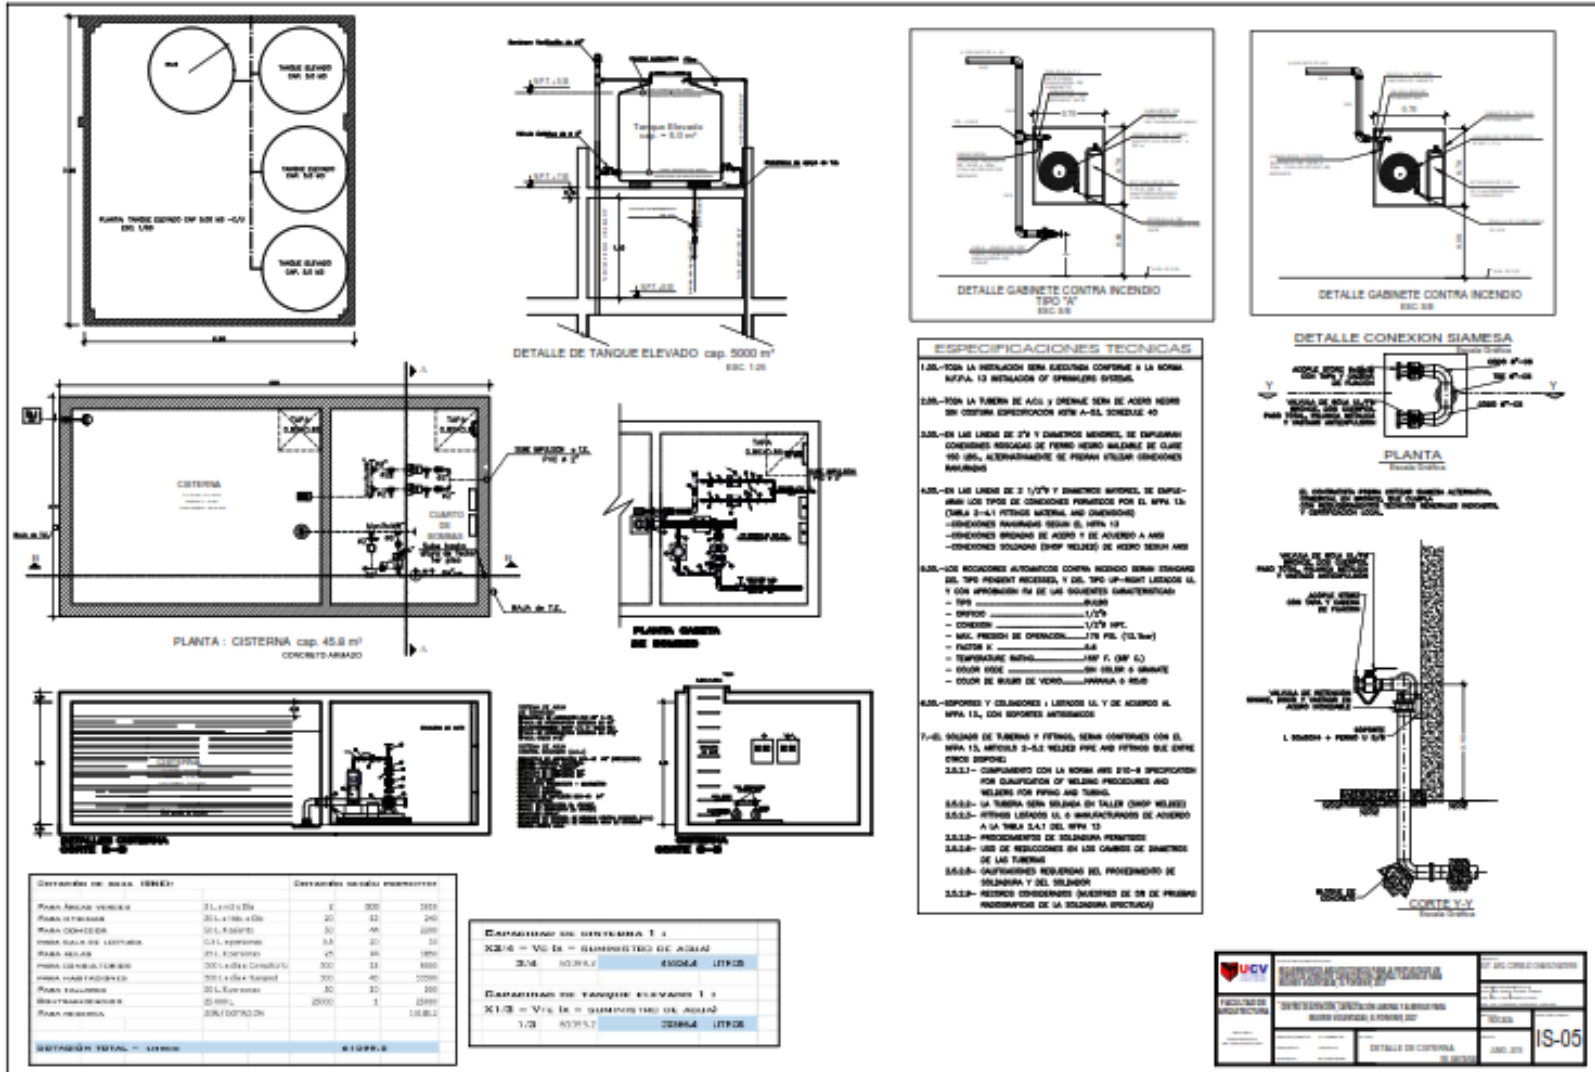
Plano de Detalles de Instalaciones Sanitarias (Cisterna).
